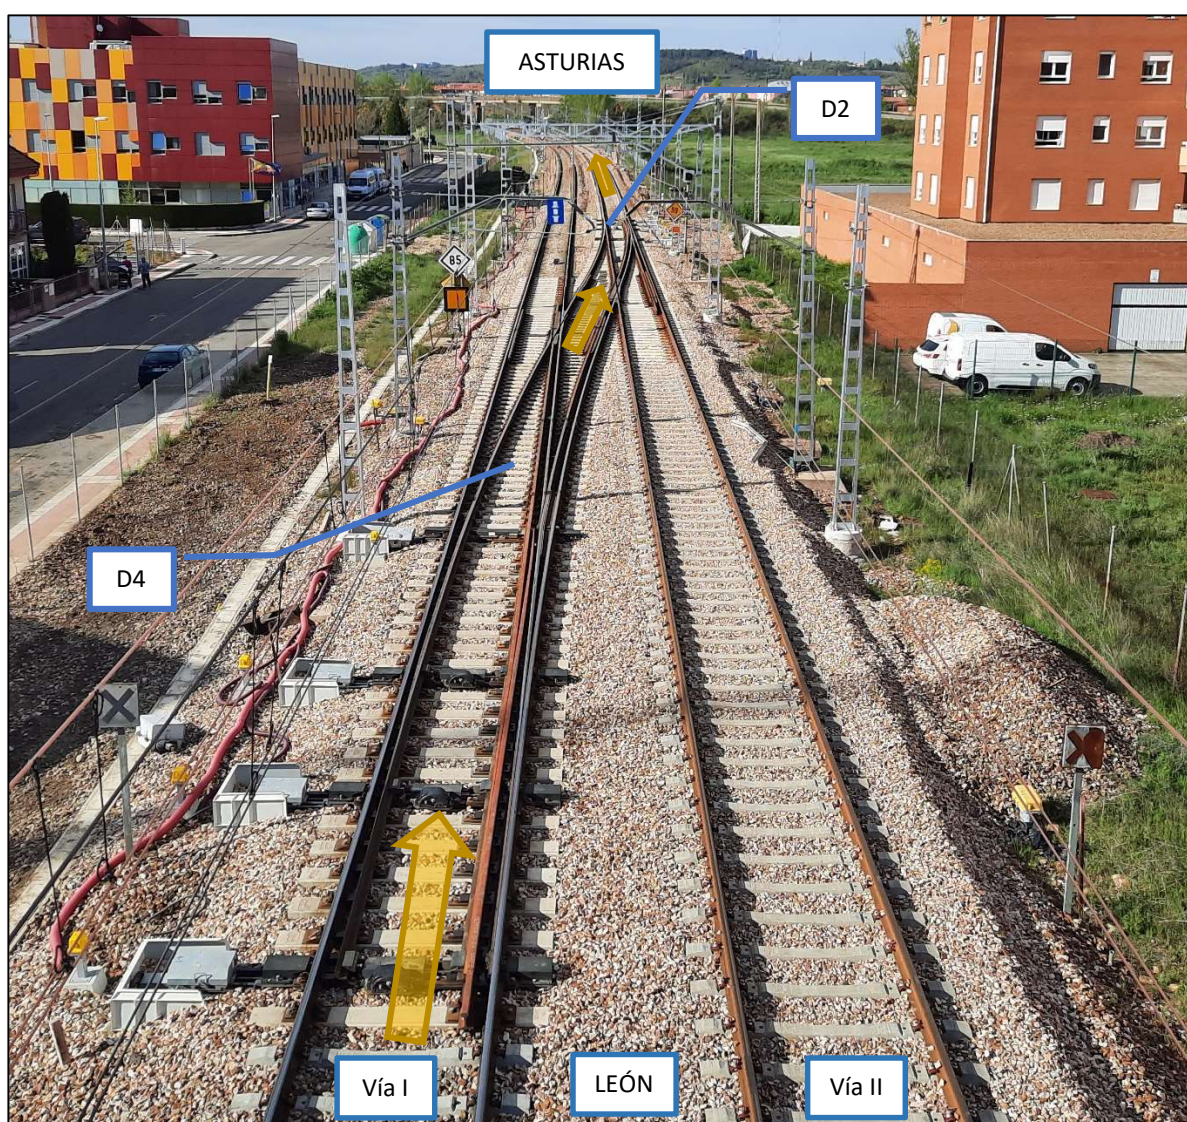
Vista del escape donde sucedió el descarrilamiento.
